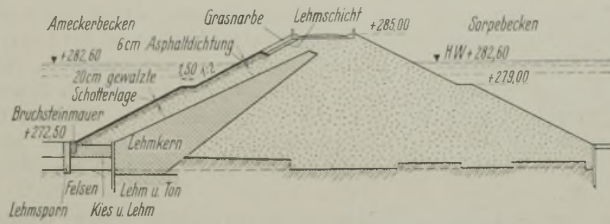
Schnitt durch den Ameckerdamm (Sorpetsperre).
